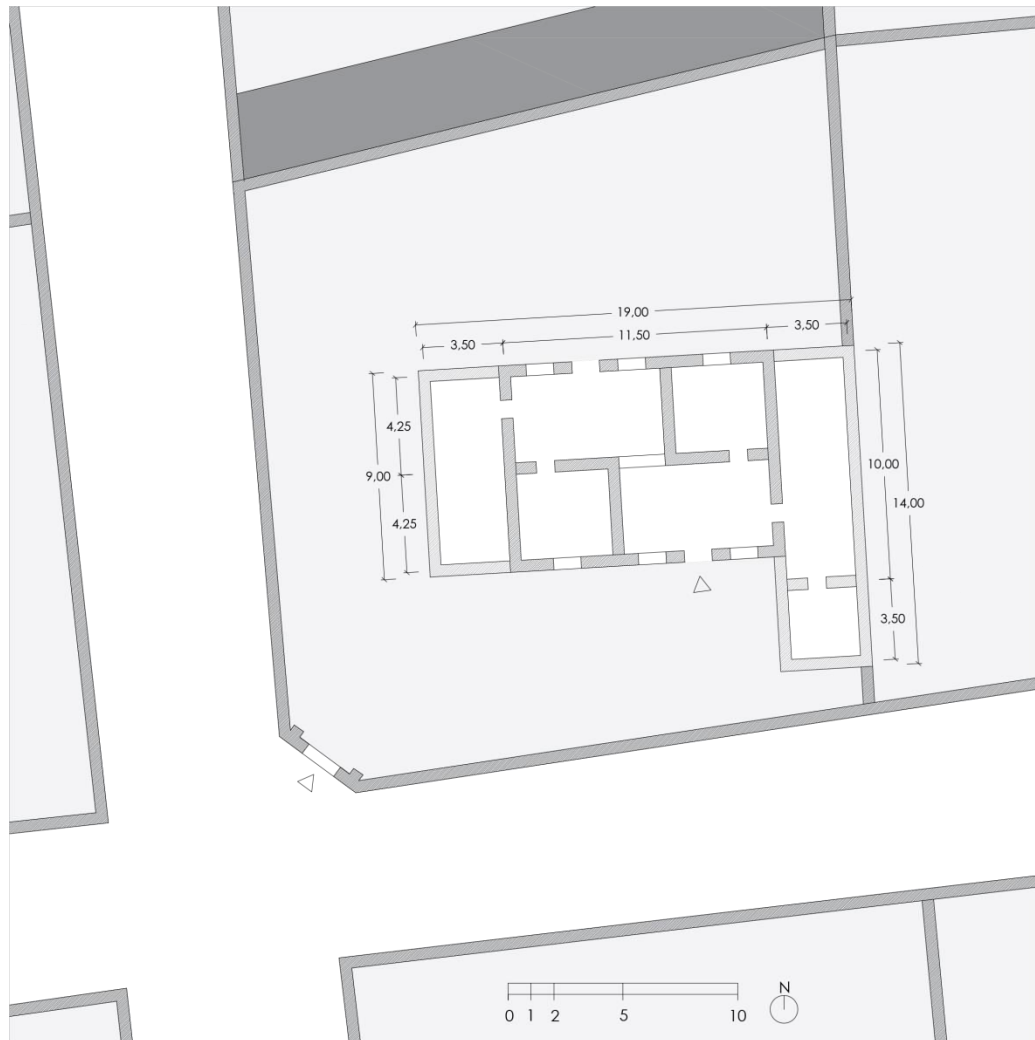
Planta de vivienda. Fuente: elaboración propia.
